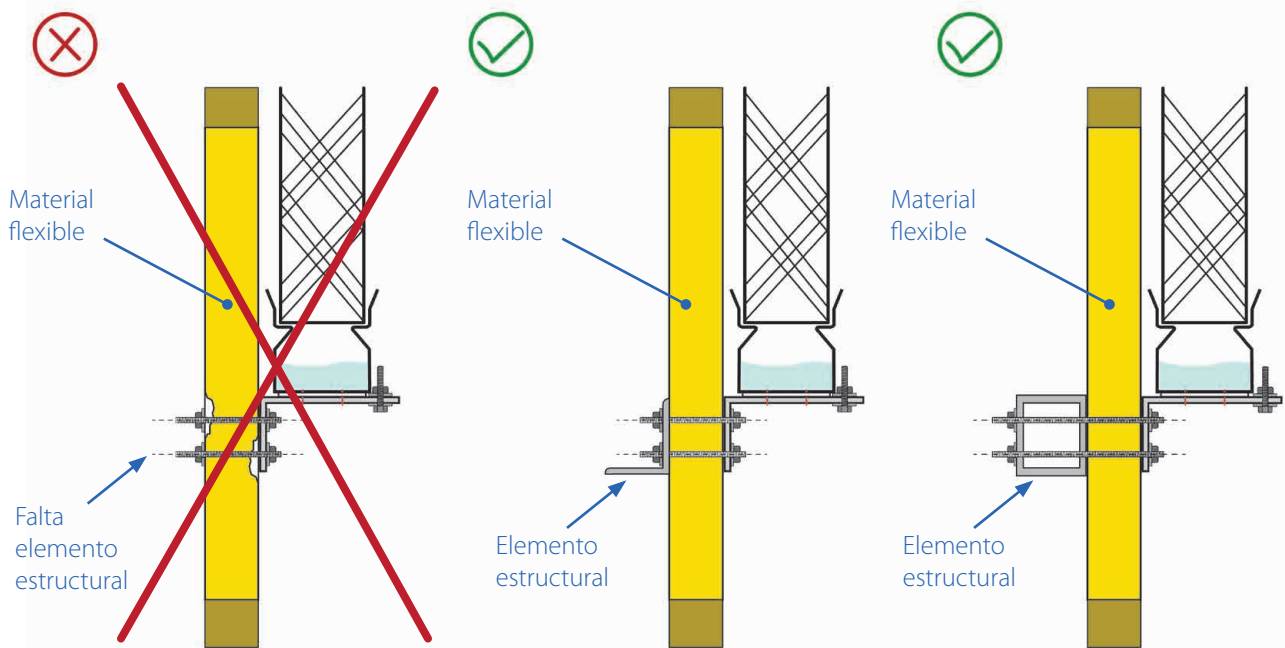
Anclaje del soporte mediante dos tornillos con taco.
